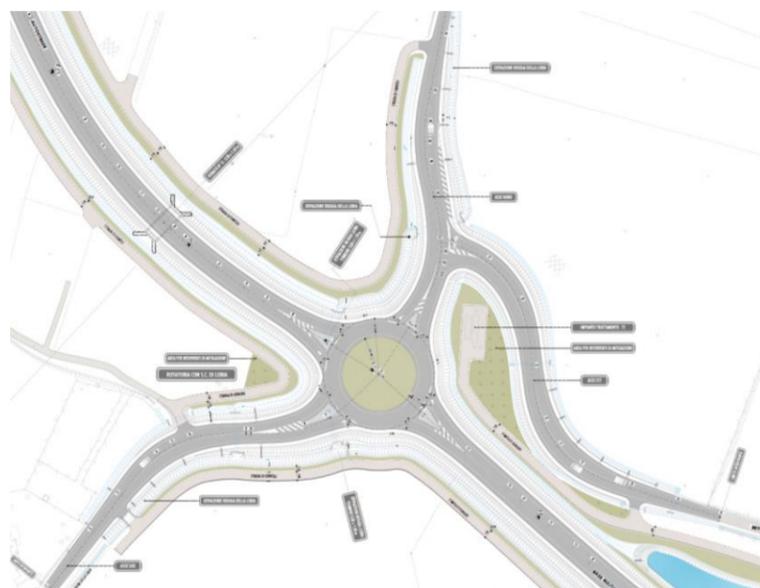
INTERSEZIONE A ROTATORIA CON S.C. LOBIA – STRALCIO PLANIMETRICO
